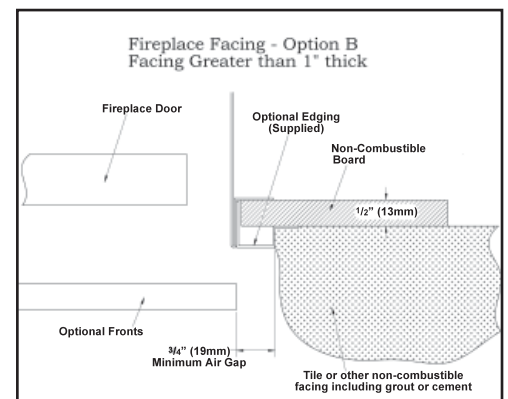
Option 2 - Revêtement du foyer avec plus de 1" (25.4mm) d'épaisseur avec façade optionnelle installée.
